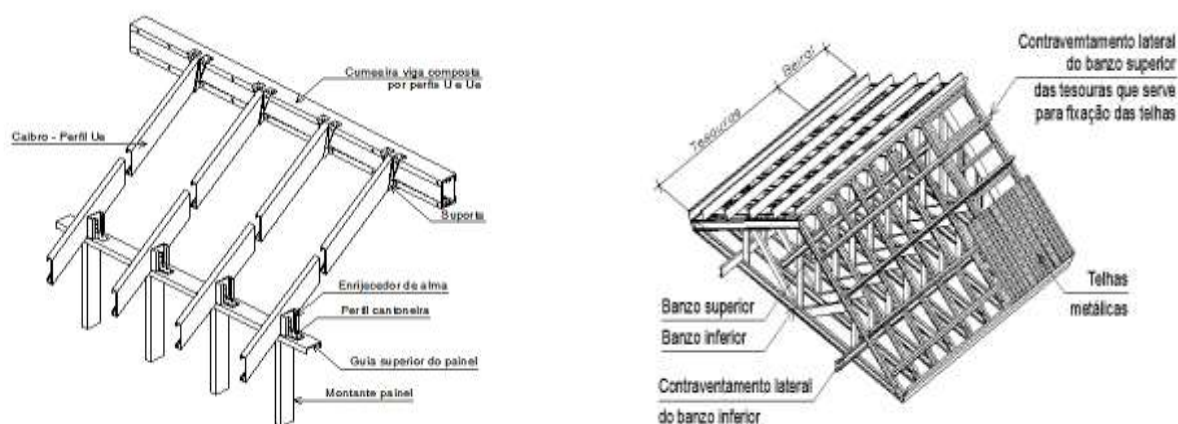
e 41 - Caibros e vigas alinhados com montantes de painel estrutural e Detalhamento estrutura de cobertura em LSF.
